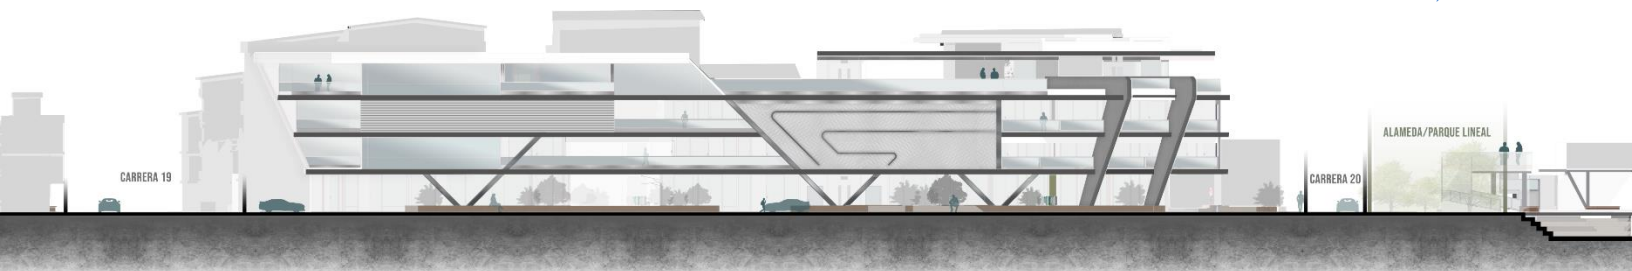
Fachada oeste calle 17 – Autoría propia.
